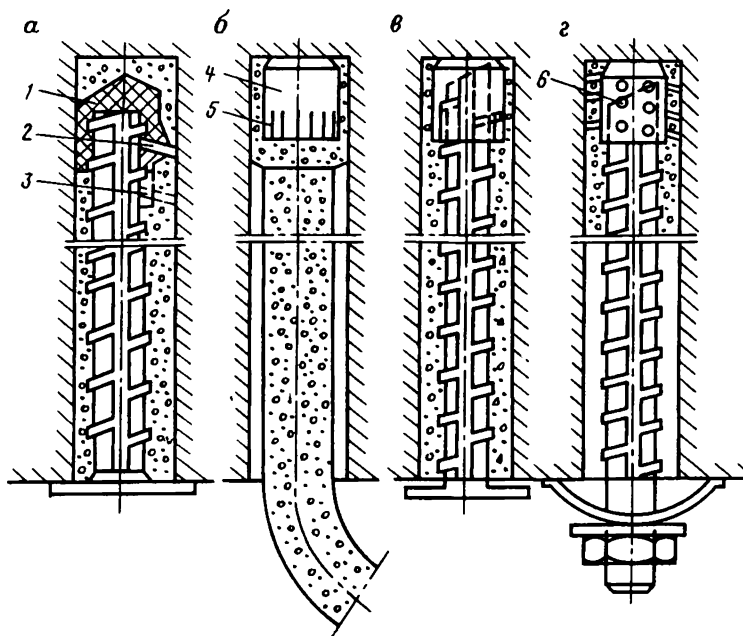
Железобетонные анкеры с комбинированным закреплением
